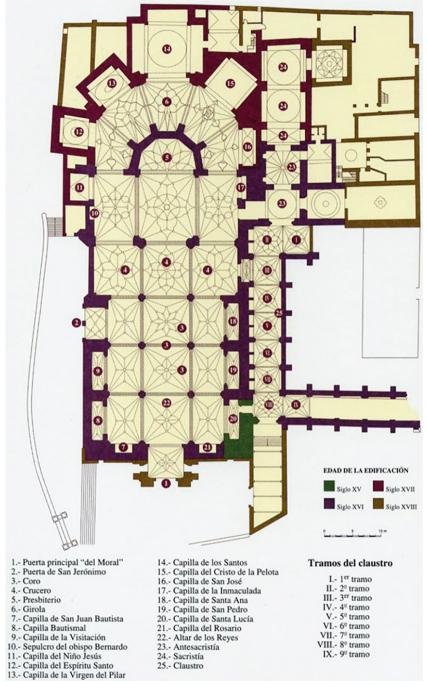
Planta de la catedral de Santa María de Calahorra*.
